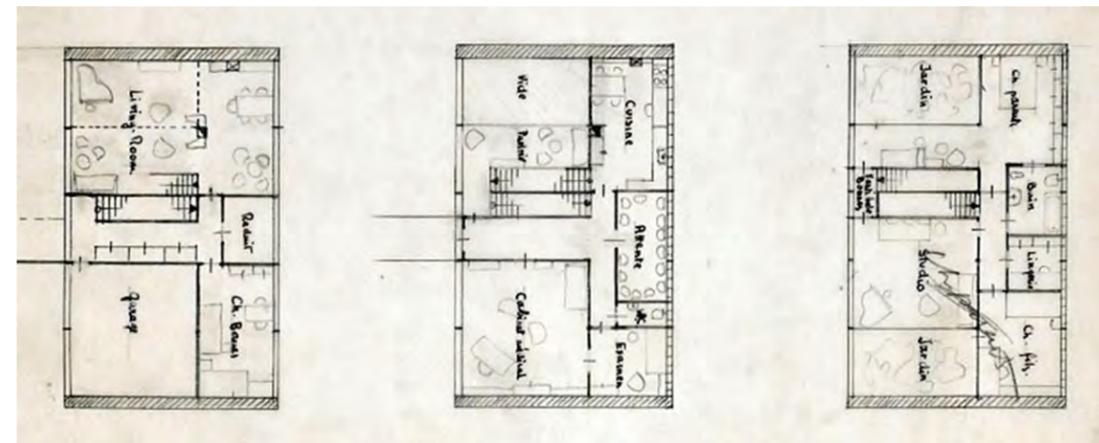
FLC 18629. Vivienda exenta en tres plantas con doble sistema de escaleras.
